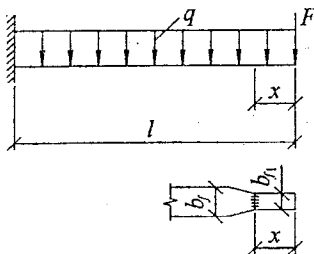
Розрахункова схема та фрагмент полочки зварної двотаврової балки
